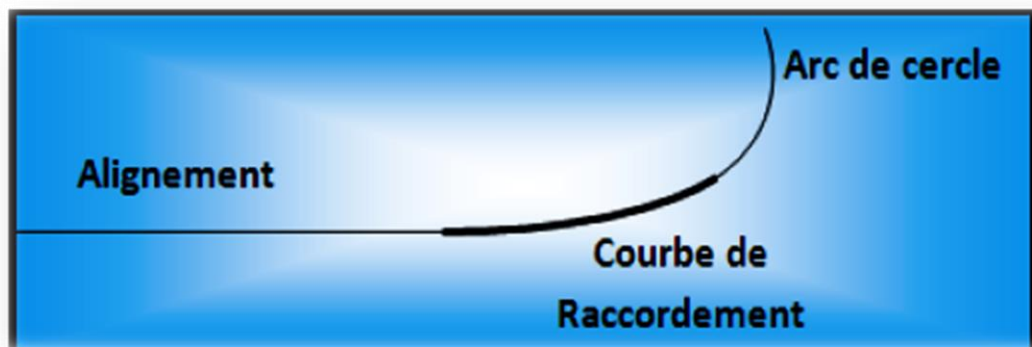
Exemple d'un Tracé en plan en 3D.
